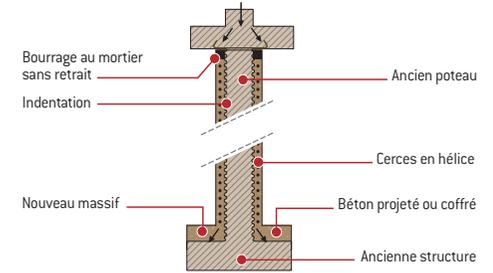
Chemisage en béton armé d'un poteau + fondation renforcée (coupe transversale)
